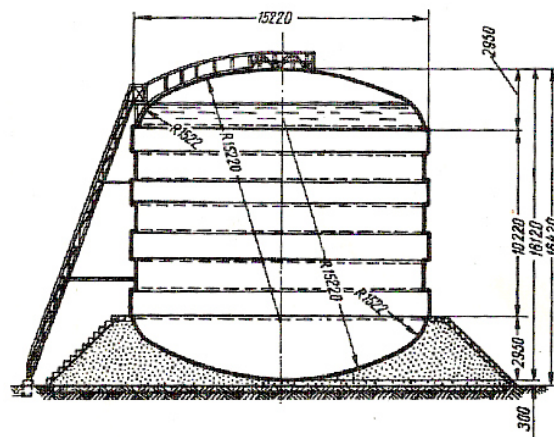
Вертикальний циліндричний резервуар із сферичним дахом і днищем
